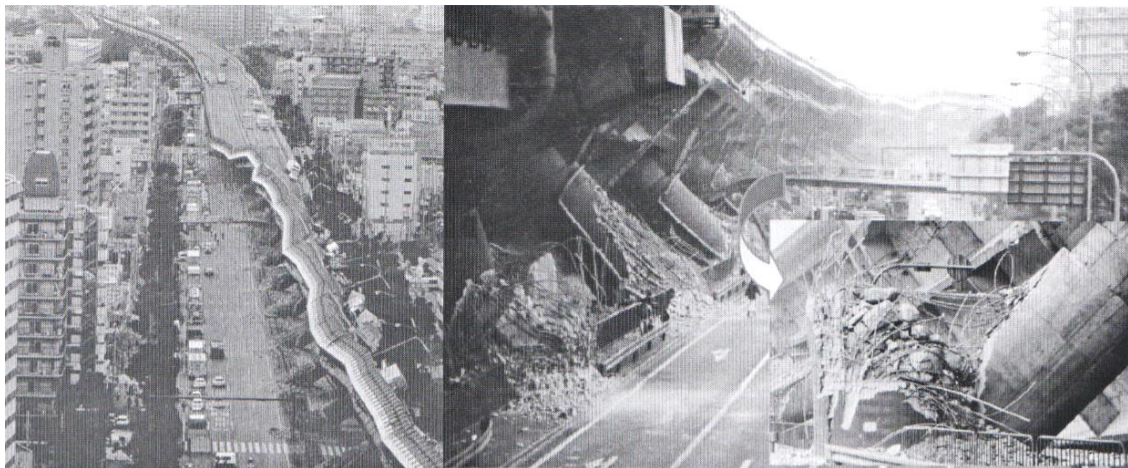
Falla a flexión en base de pila en la autopista de Hanshin en el terremoto de Kobe 1995, vista en planta-izquierda y elevación-derecha (International Federation for Structural Concrete, 2007).
